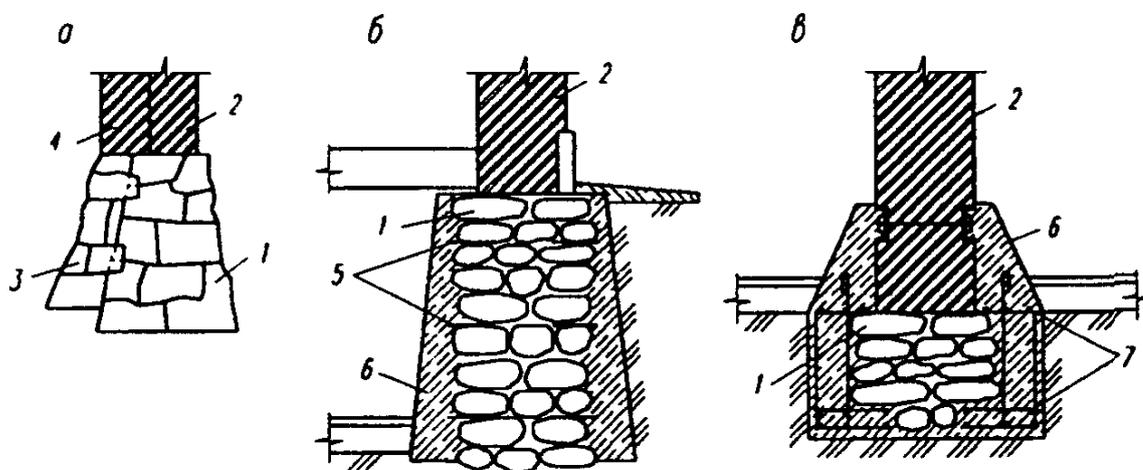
Примеры традиционных способов усиления фундаментов: а - «прикладом» из природного камня; б - банкетом из бетона; в - железобетонной обоймой: 1 - бутовая кладка; 2 - кирпичная стена; 3 - «приклад» из камня; 4 - уширение стены (кирпич); 5 - металлические штыри-анкеры; 6 - бетон; 7 - стальная арматура
